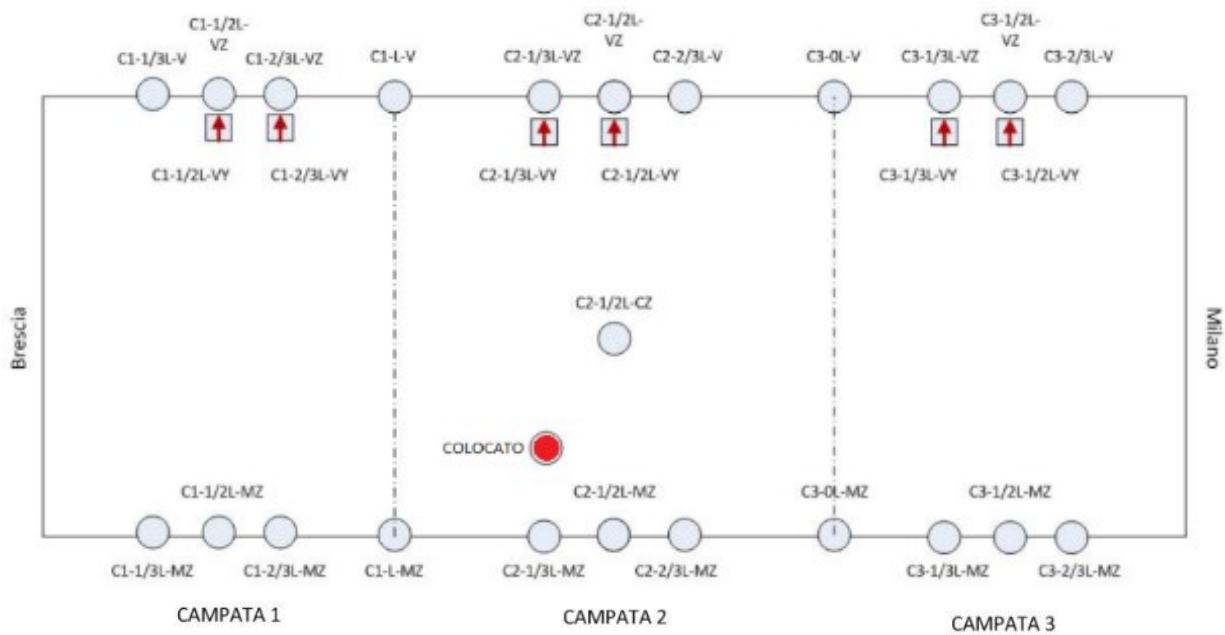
schema posizione sensori prova con forzamento verticale (carreggiata Nord).
